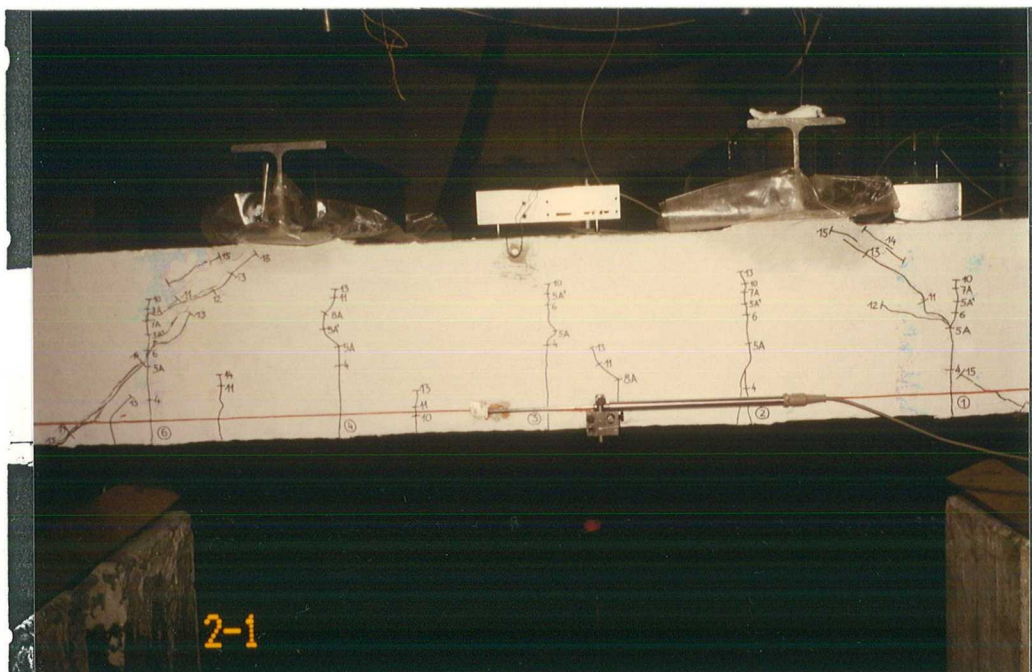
Versuch II/1 nach dem Versagen durch Schubbruch
